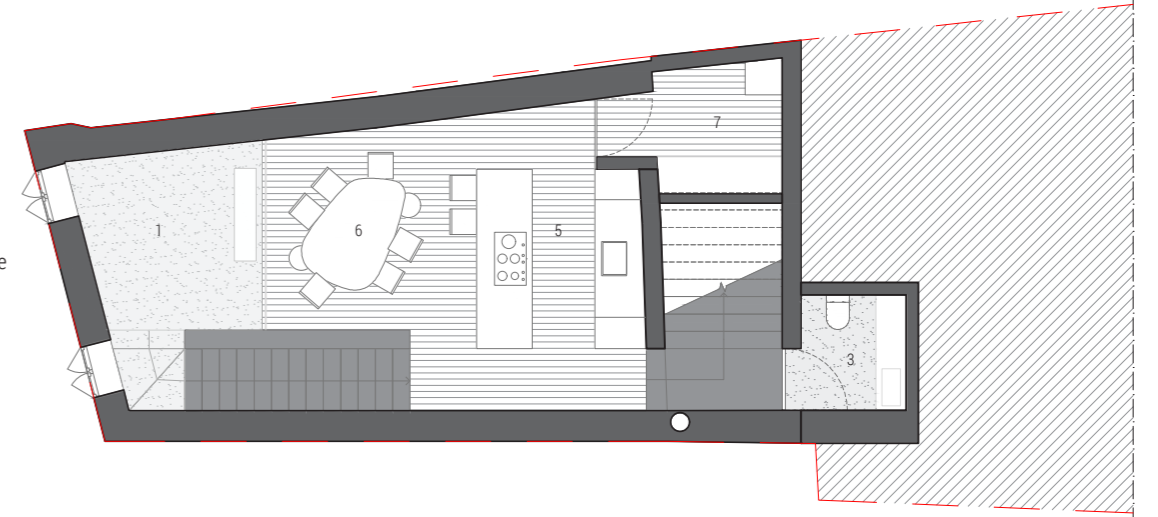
Planta do Piso 3 do projeto de Arquitetura.
